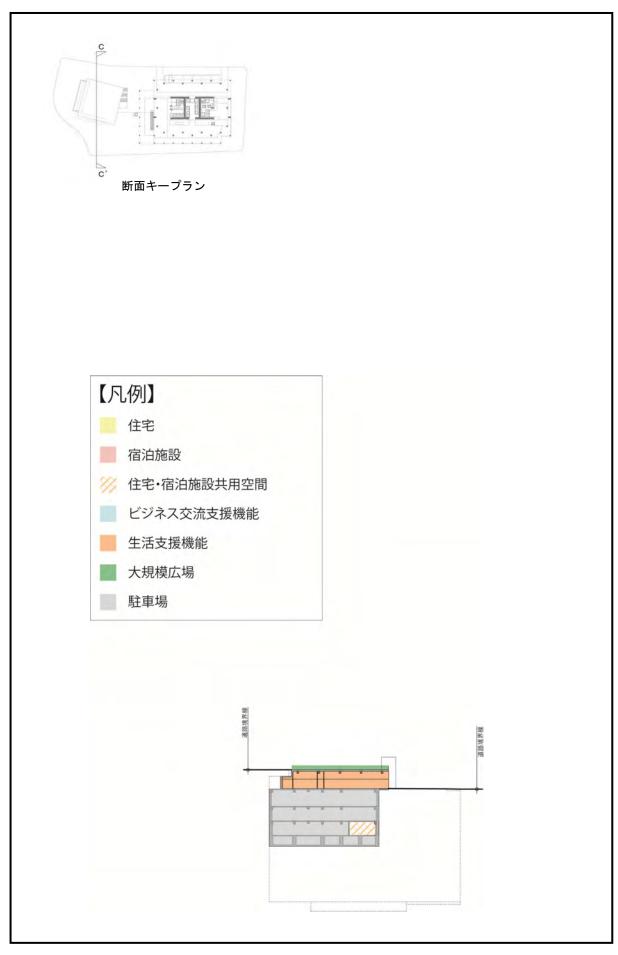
(5) 断面図 (C-C'断面 S=1:1, 200) 【変更前】
